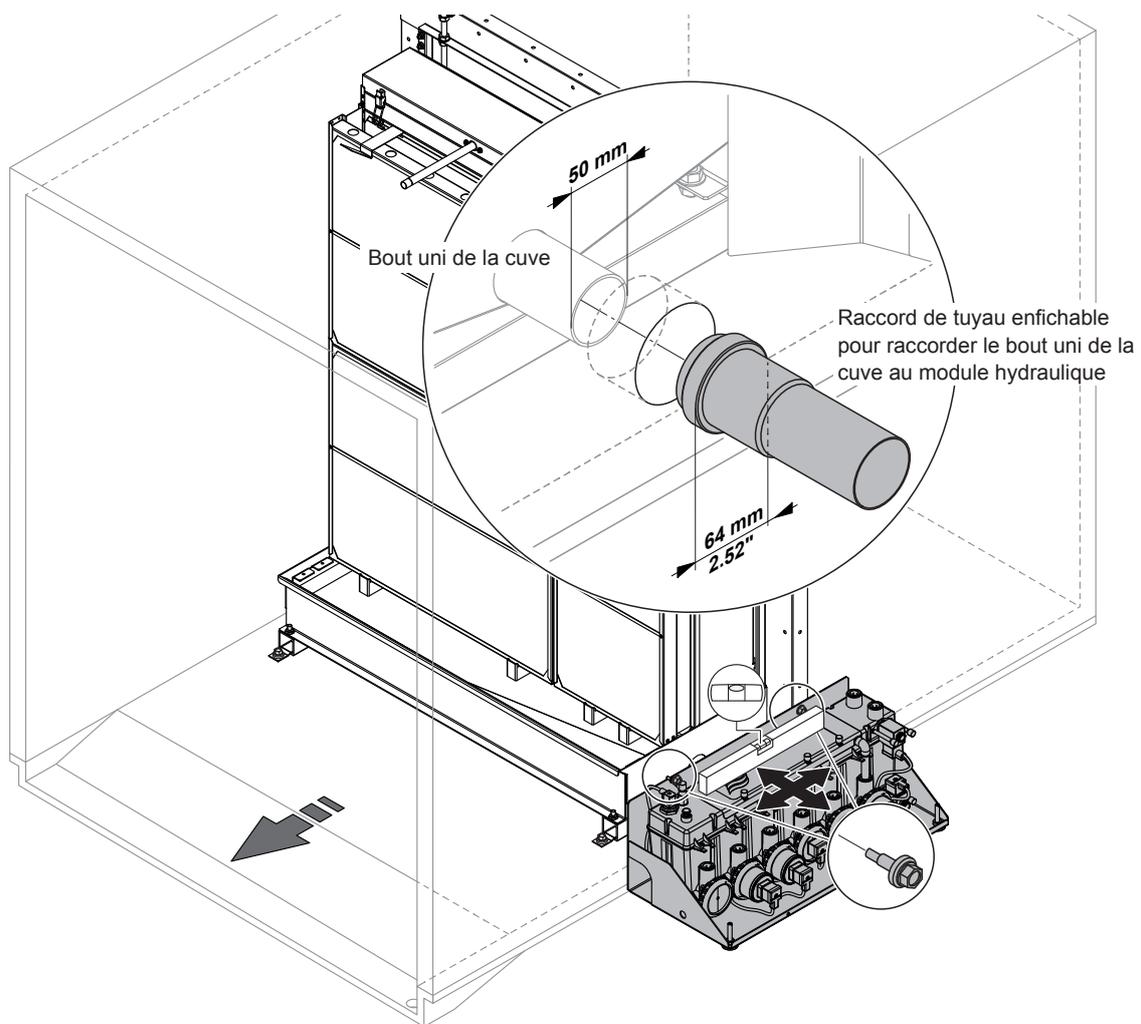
Montage du module hydraulique, installation externe, cuve d'eau avec vidange latérale
